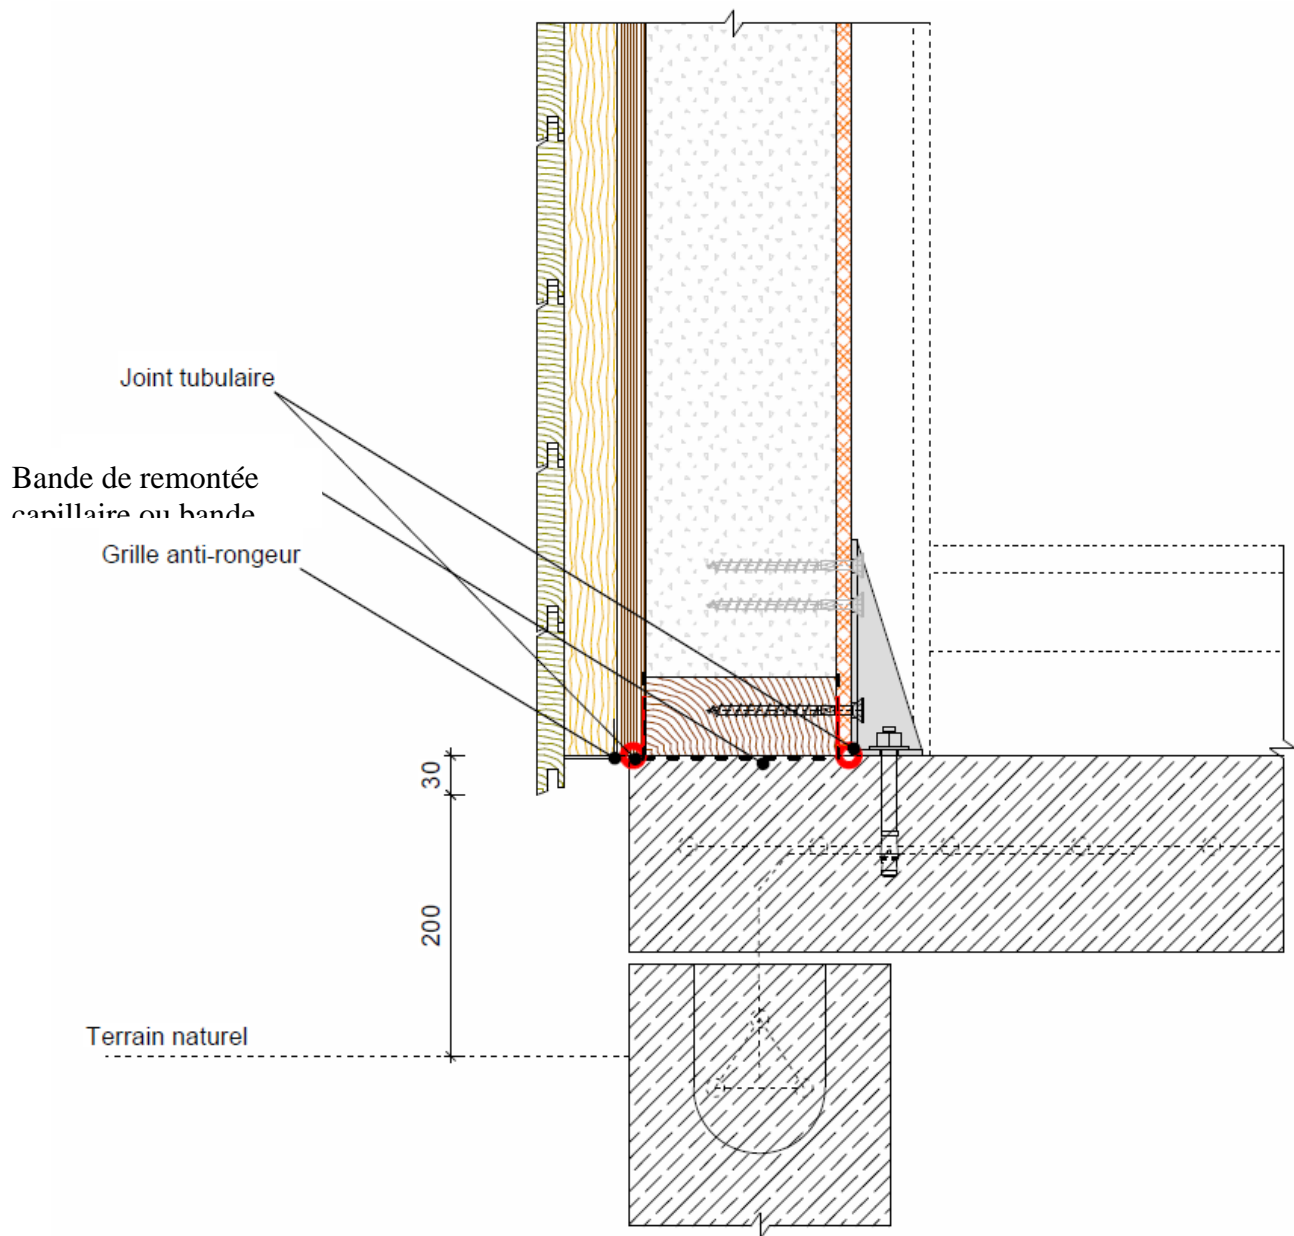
Pied de mur SYBOIS MUR – Jonction avec la dalle basse
